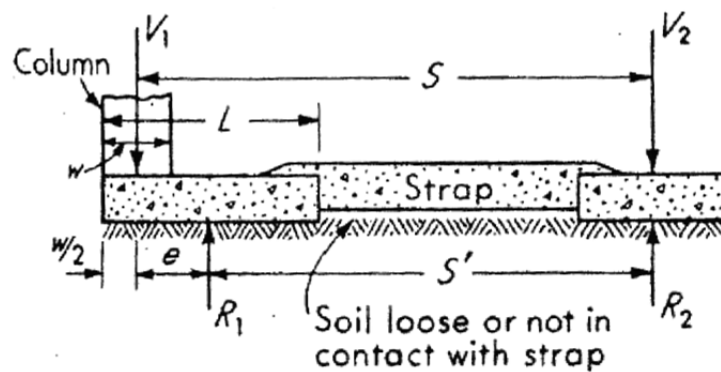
Zapatas aisladas unidas mediante viga. Bowles [13].
